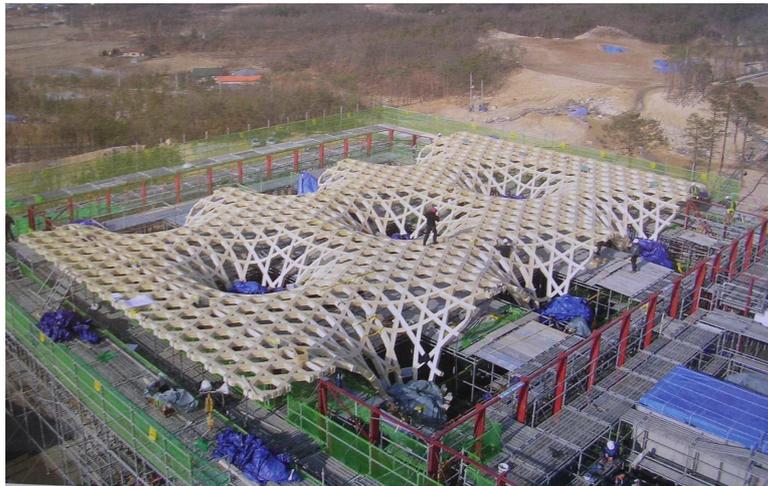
Dachkonstruktion vor der Montage des Trägerrostes
